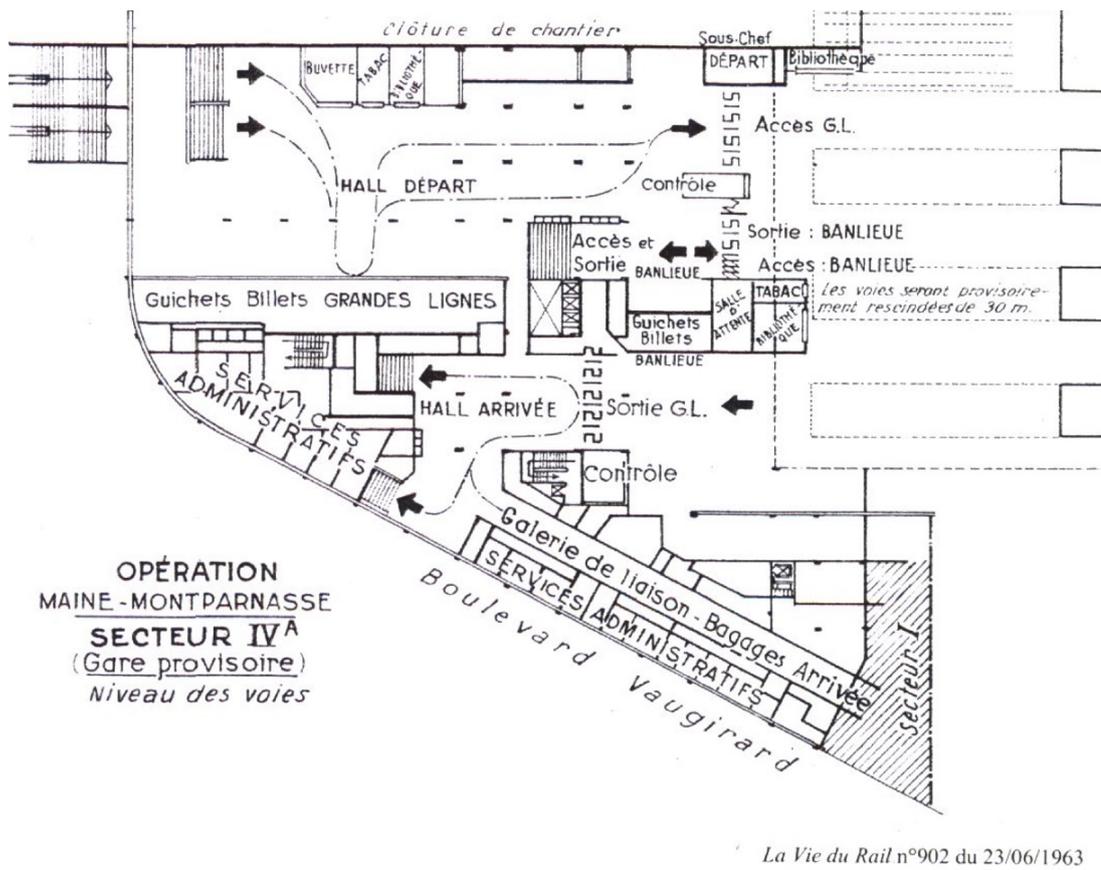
Plan du niveau +1 de la première aile de la gare de Maine-Montparnasse— Source : LVDR, 1963
